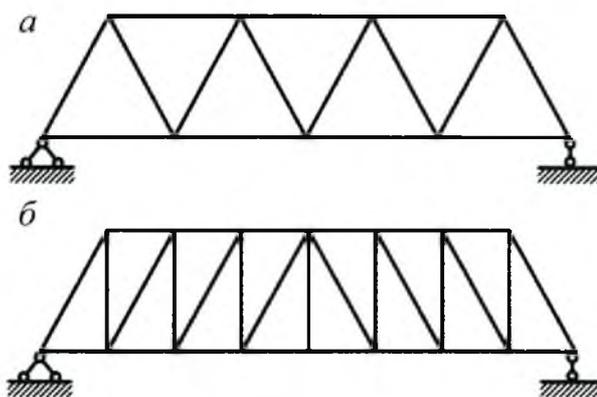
Типы железобетонных ферм: *a* — с треугольной решеткой; *б* — с раскосой решеткой
